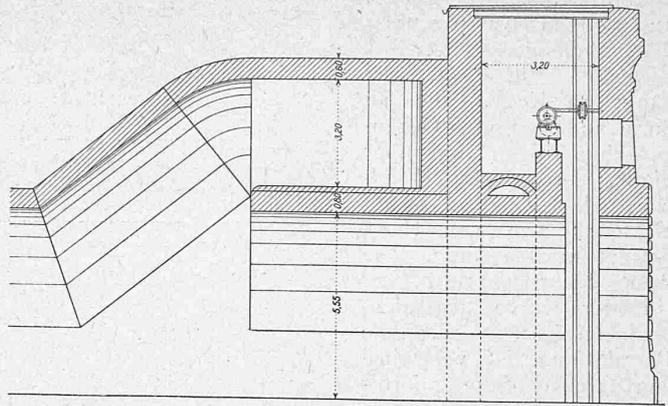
Einmündung („Pfeife“) des Luftkanals in den Tunnel, Längsschnitt (rechts das Tunnelportal). — 1:200.
